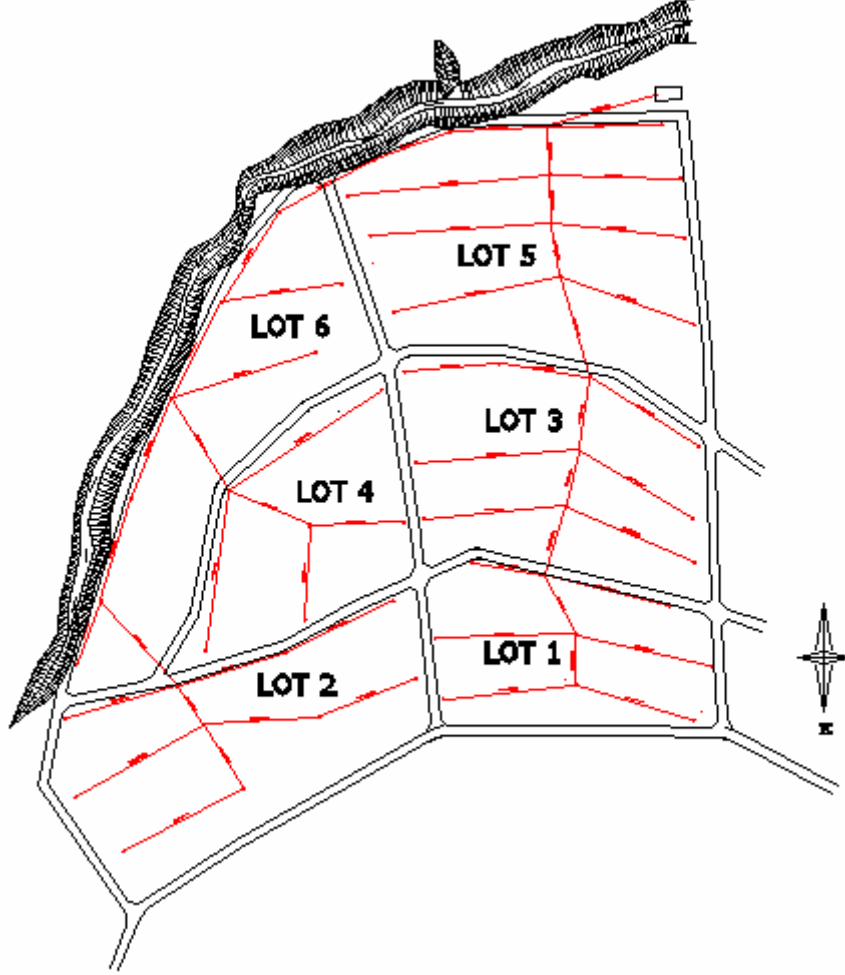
Katı Atık Düzenli Depolama Alanı Yapıların Vaziyet Planı
